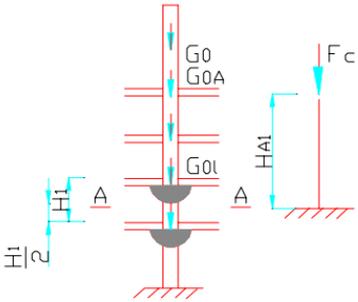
一层或数层节点刚接后搁置状态时柱的计算简图
